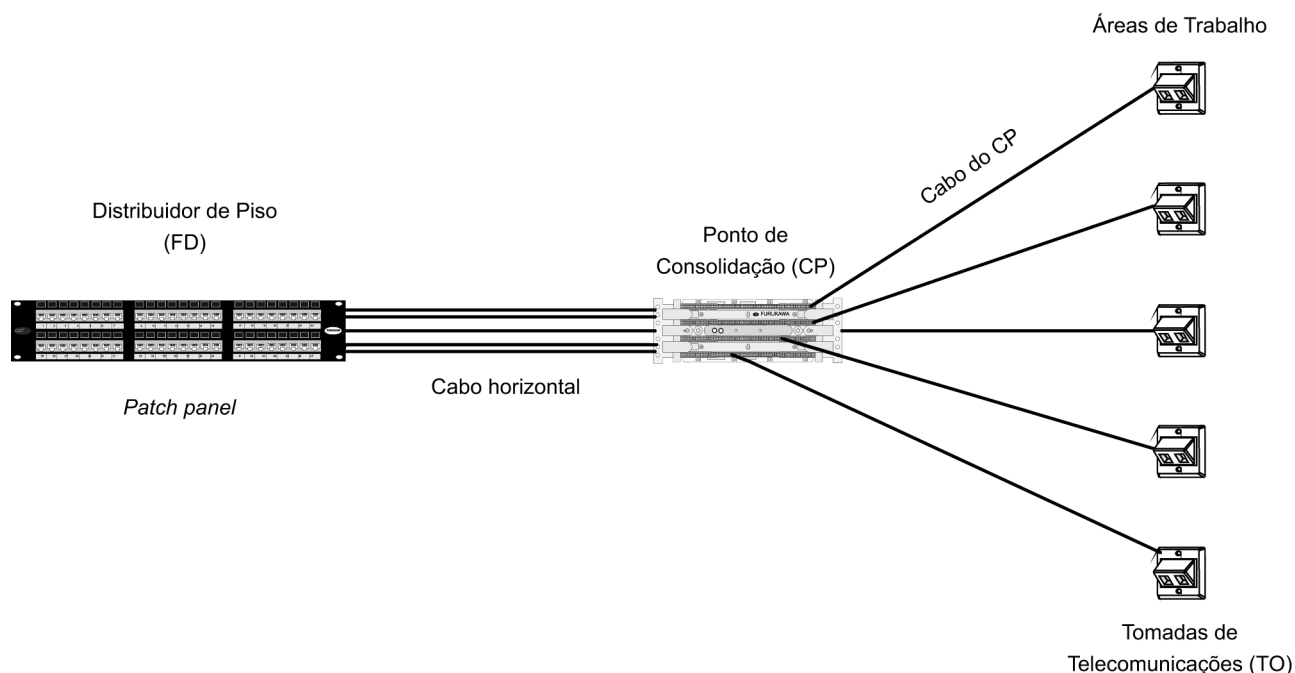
Cabeamento horizontal com ponto de consolidação (CP).
